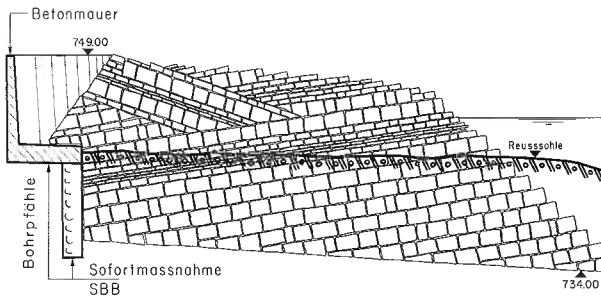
Hauptschutzelement A. Nachbildung eines Felssporns mit Blocksteinen.
